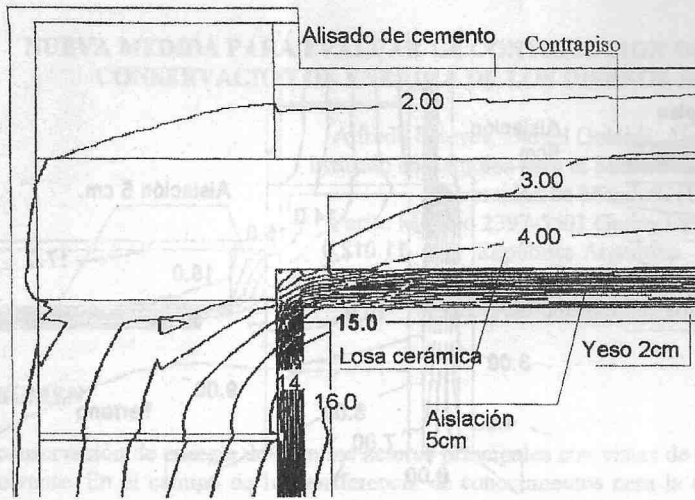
Encuentro muro / techo, aislado interiormente.
